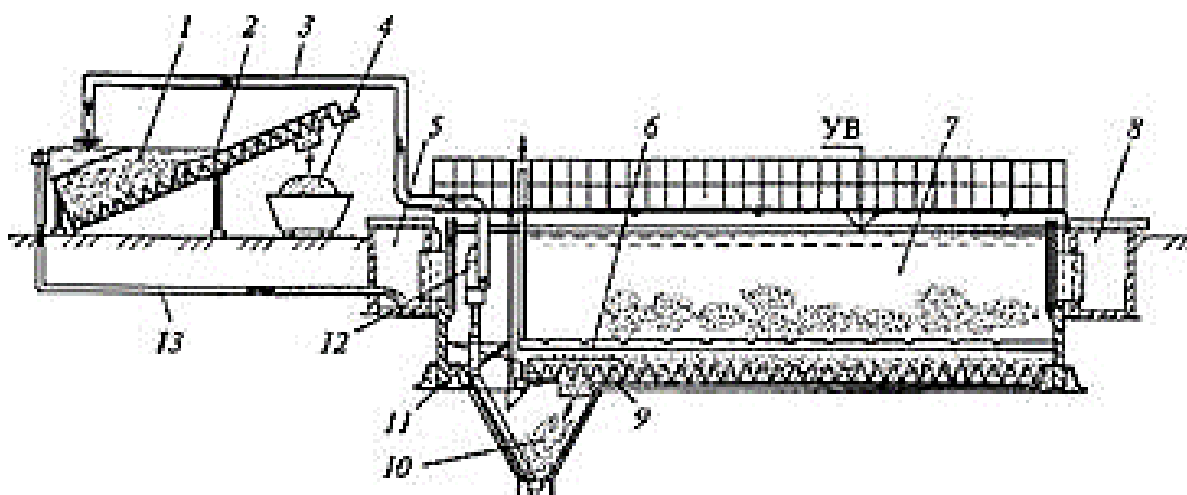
Продольный разрез аэрируемой песколовки с гидроклассификатором:
